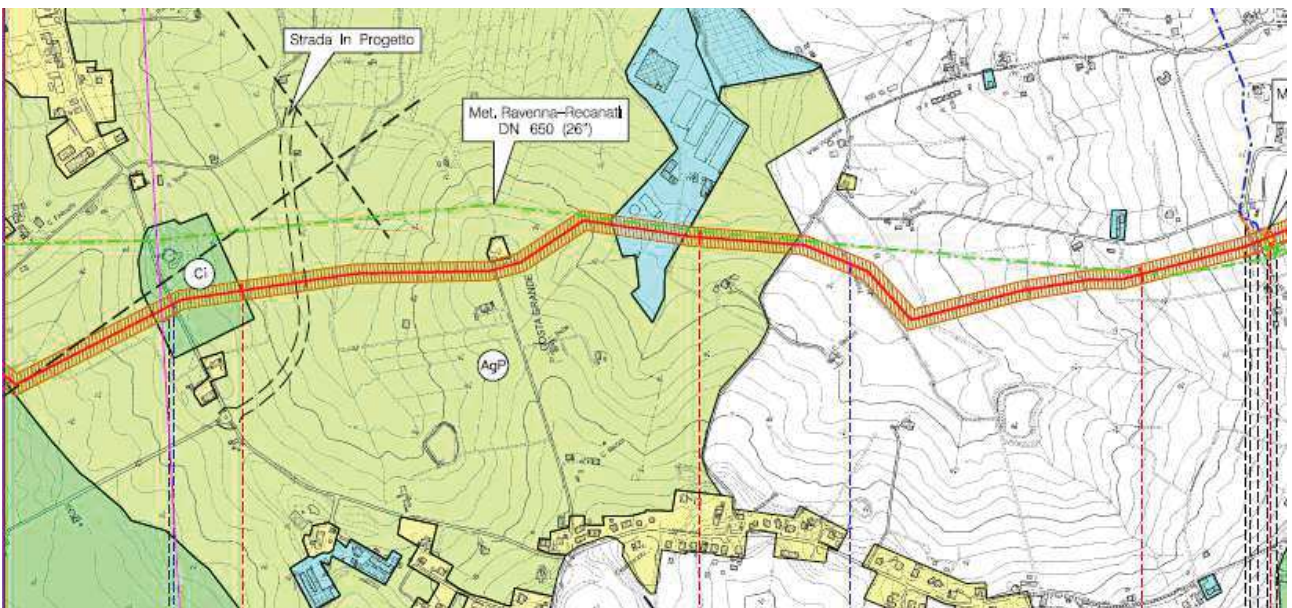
Stralcio Tav. PG-VPE-110 (Planimetria con VPE e strumenti di pianificazione urbanistica) – II° tratto zona (via della Repubblica - via Bruschetto)
